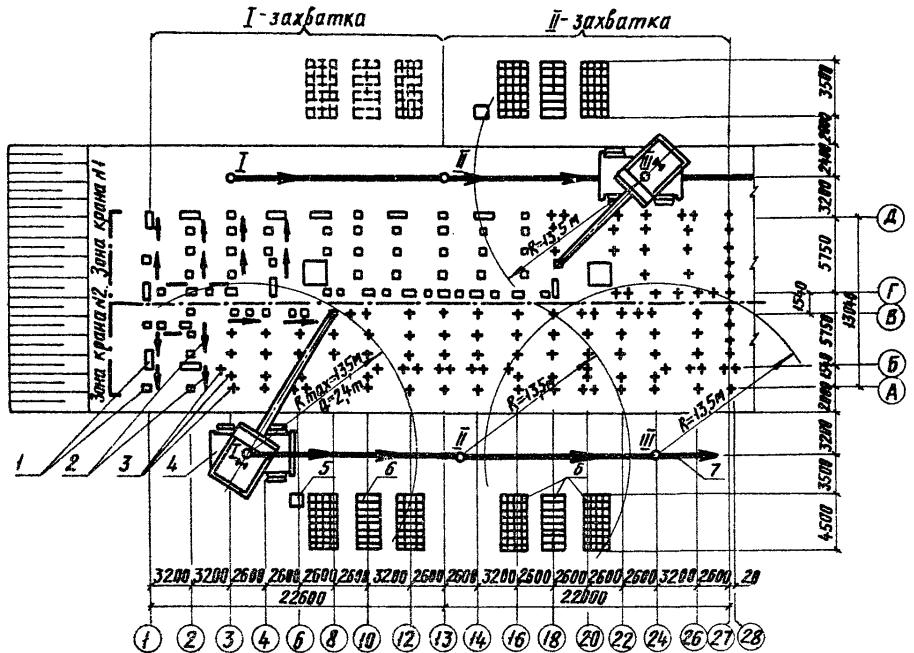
Схема организации работ по монтажу оголовков: I-смонтированные оголовки; 2-направление монтажа; 3-забойные сваи; 4-пневмоколесный кран К-161; 5-ящик для приема бетона; 6-шабель оголовков; 7-ось движения крана; I, II-стоянки крана
